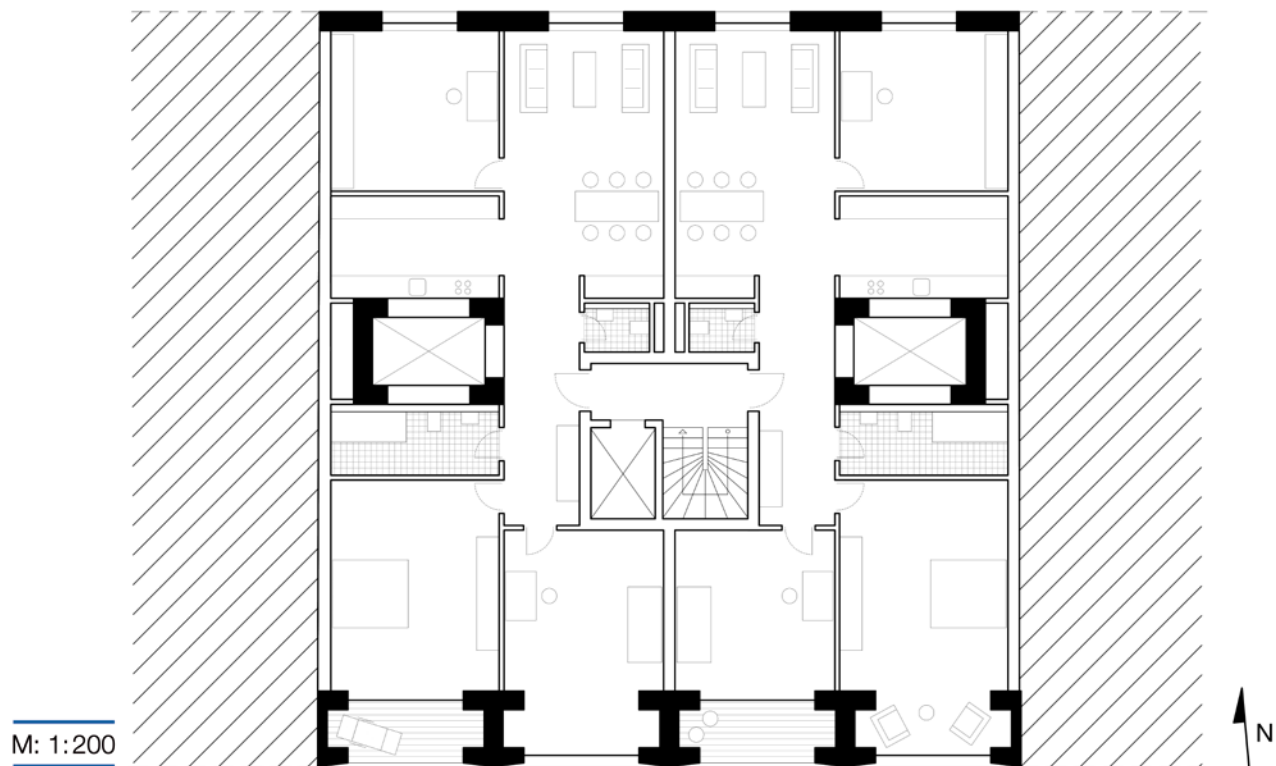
Typenentwurf »Baulücke« in Fertigteilbauweise, Grundriss Regelgeschoss
